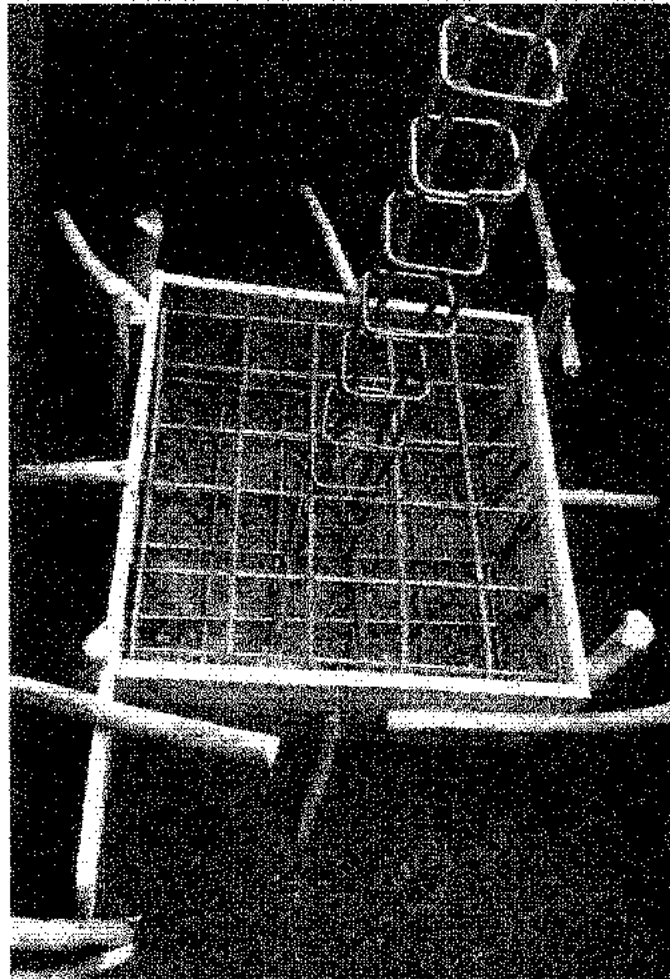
Cassero e armatura per il getto di calcestruzzo
